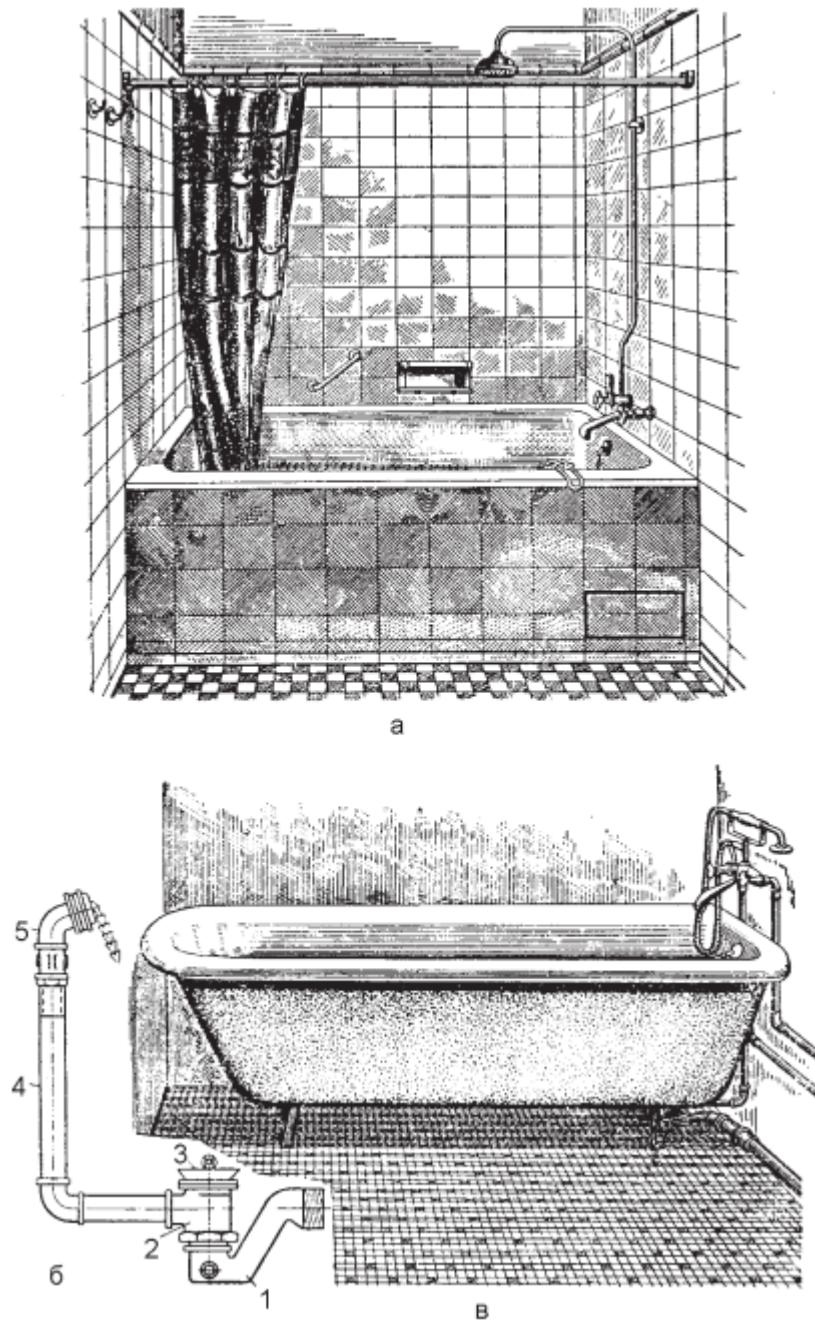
Ванны: а – прямобортная; б – деталь переливной трубы; 1 – напольный сифон; 2 – тройник; 3 – выпуск из ванны; 4 – переливная труба; 5 – перелив; в – ванна круглобортная
